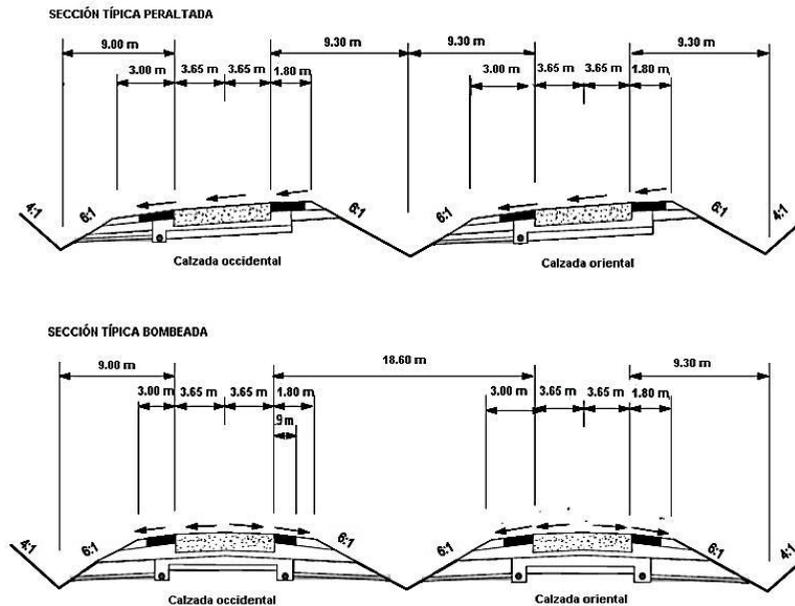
Secciones transversales típicas de algunas carreteras de doble calzada.
